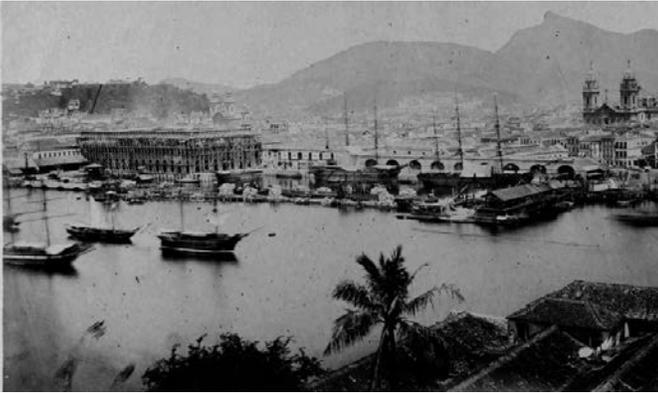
Alfandega em construção vista da Ilha das Cobras (molhe em destaque).
